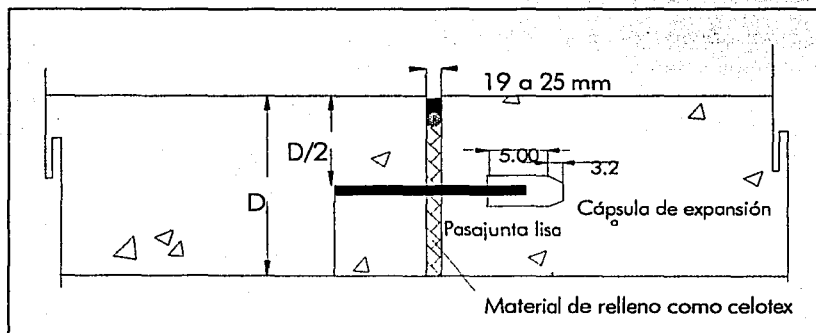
Junta transversal de expansión/aislamiento con pasajunta lisa.
